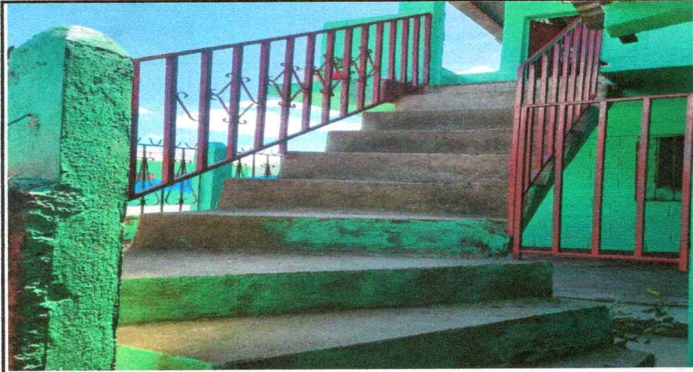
Colocación de piso antideslizante en las gradas de la planta alta nivel primario
